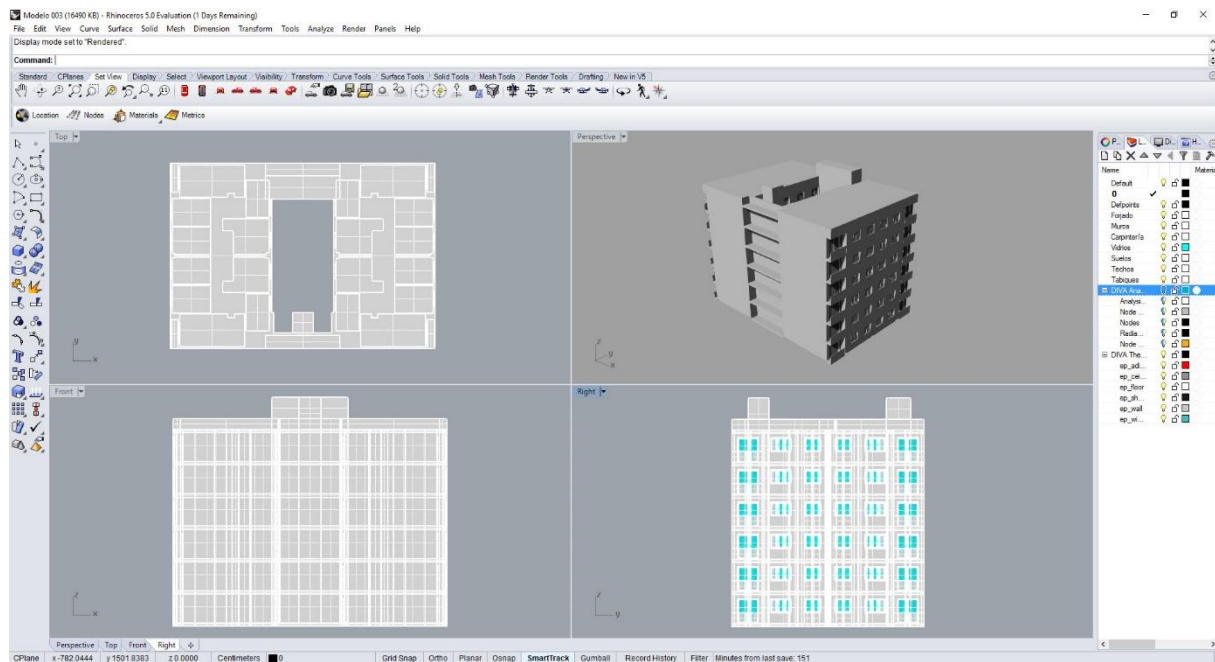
Edificio N°2. Plantas y alzados del módulo de cuatro viviendas.
